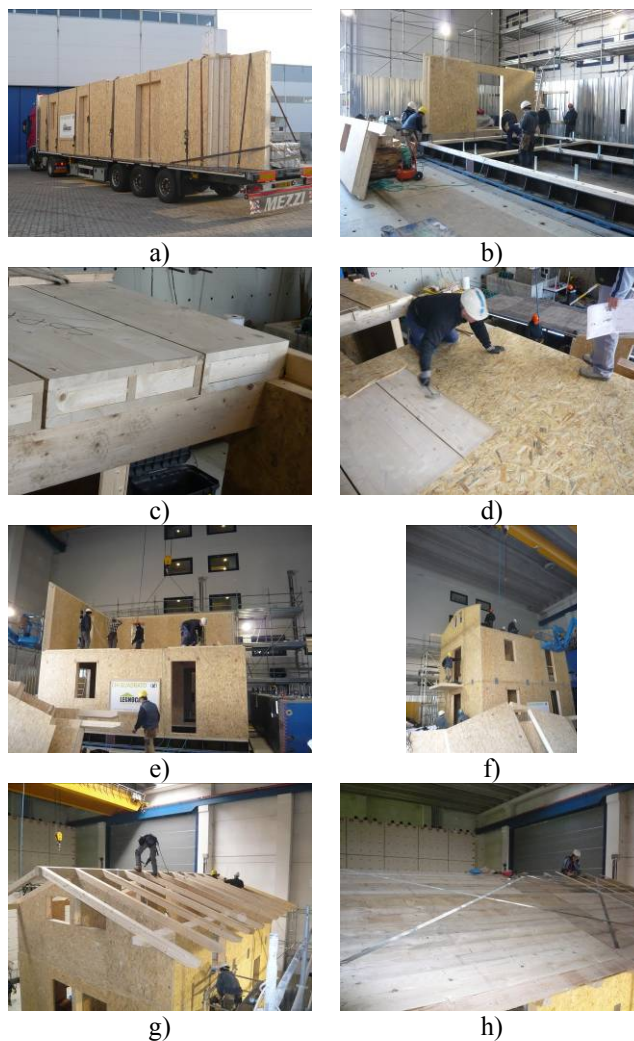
Fasi di montaggio. a: Trasporto degli elementi strutturali - b: Montaggio delle pareti al piano terra - c: Posa degli elementi di solaio - d: Posa e chiodatura dei pannelli OSB per l'irrigidimento di piano - e: Montaggio delle pareti al secondo piano - f: Montaggio delle pareti al terzo piano - g: Posa dei travetti di copertura - h: Chiodatura dei nastri forati per l'irrigidimento di piano della copertura
